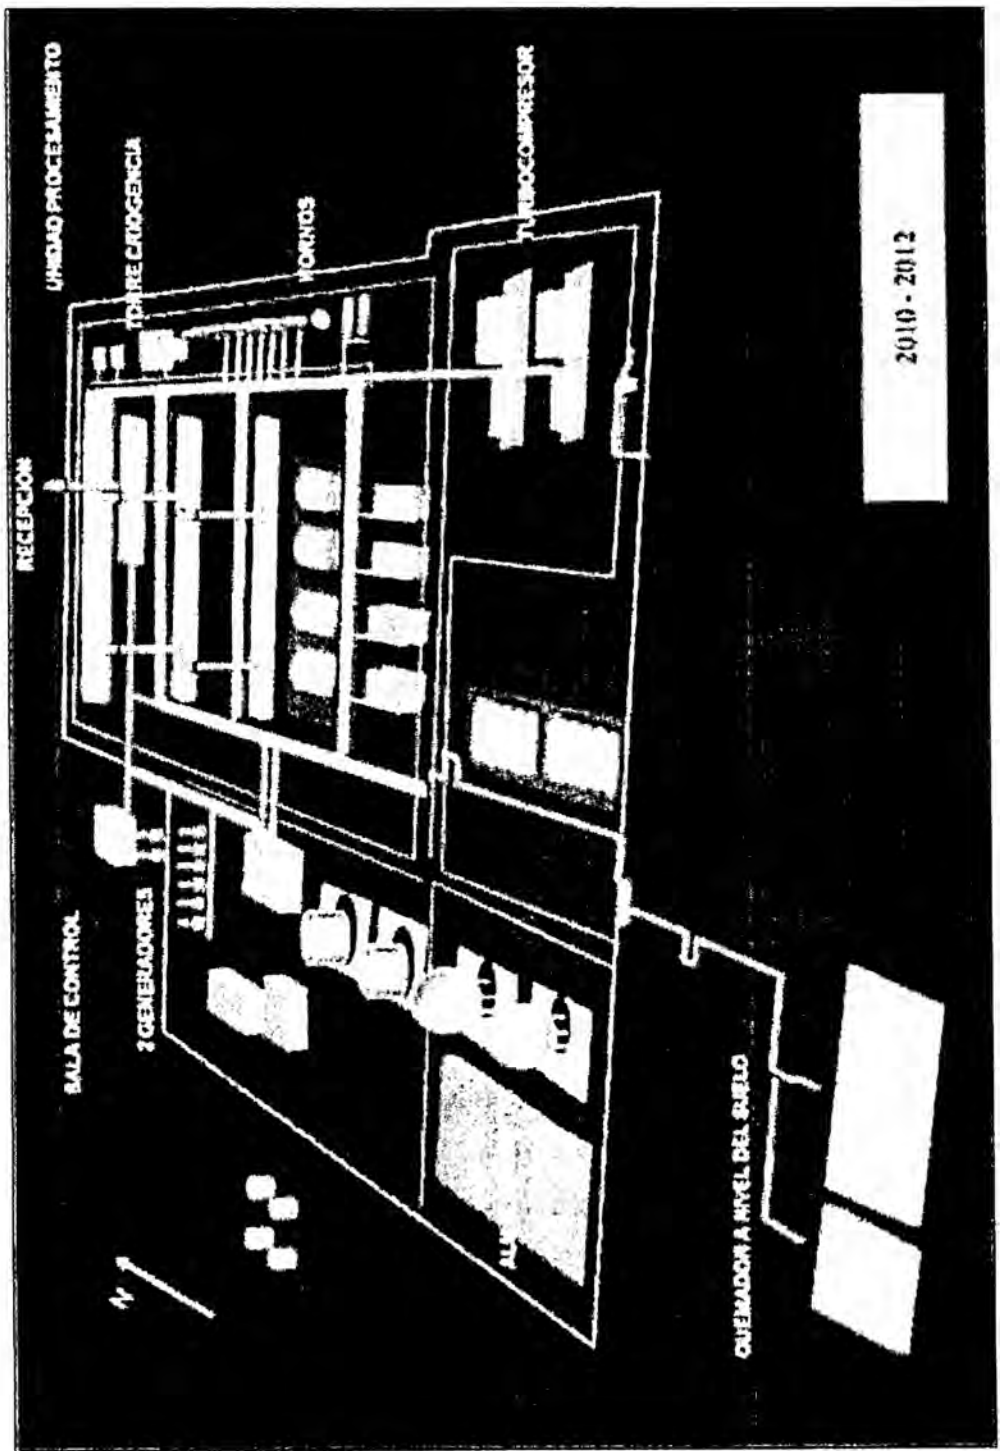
Esquema de la Planta de Separación de Gas Natural "Malvinas"
